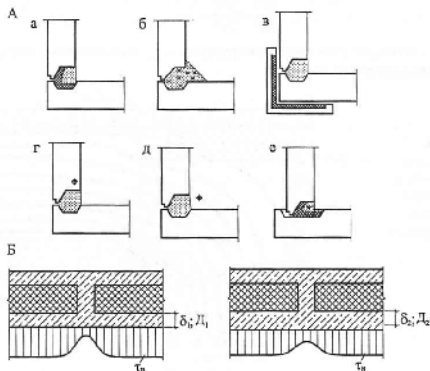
Конструктивная корректировка теплотехнических качеств наружных стен. А – утепление угловых стыков панельных наружных стен: а – вкладышами из эффективного утеплителя, б – утепляющим внутренним слоем из монолитного легкого бетона, в – наружной пиястрой, г – замоналическим слоем отслаивания, д – открытым стояком, е – нахлесткой панелей и утепляющим вкладышем; Б – повышение температуры внутренней поверхности в зонах теплопроводных включений и повышение равномерности распределения температур на внутренней поверхности трехслойных стен за счет повышения инерционности внутреннего слоя
